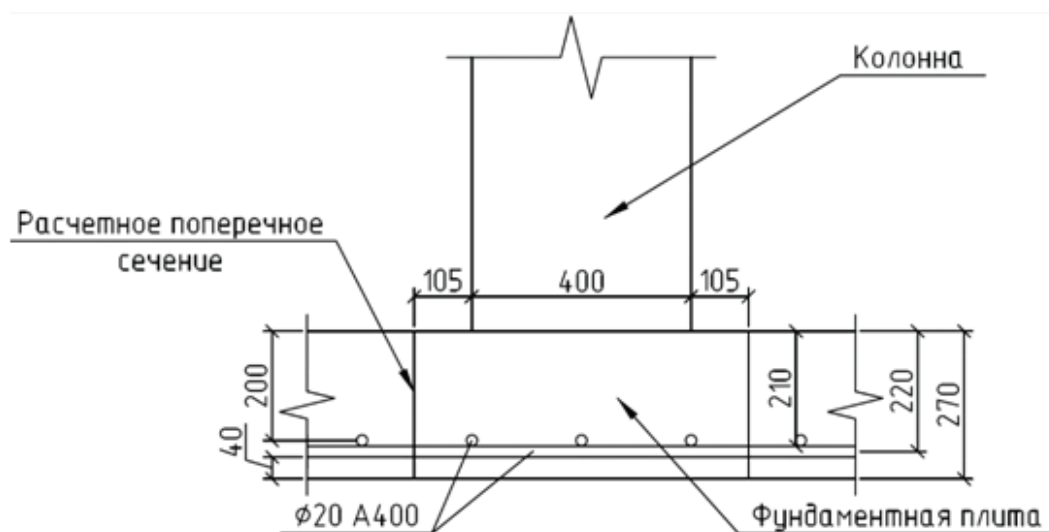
Узел сопряжения существующей колонны с фундаментом
